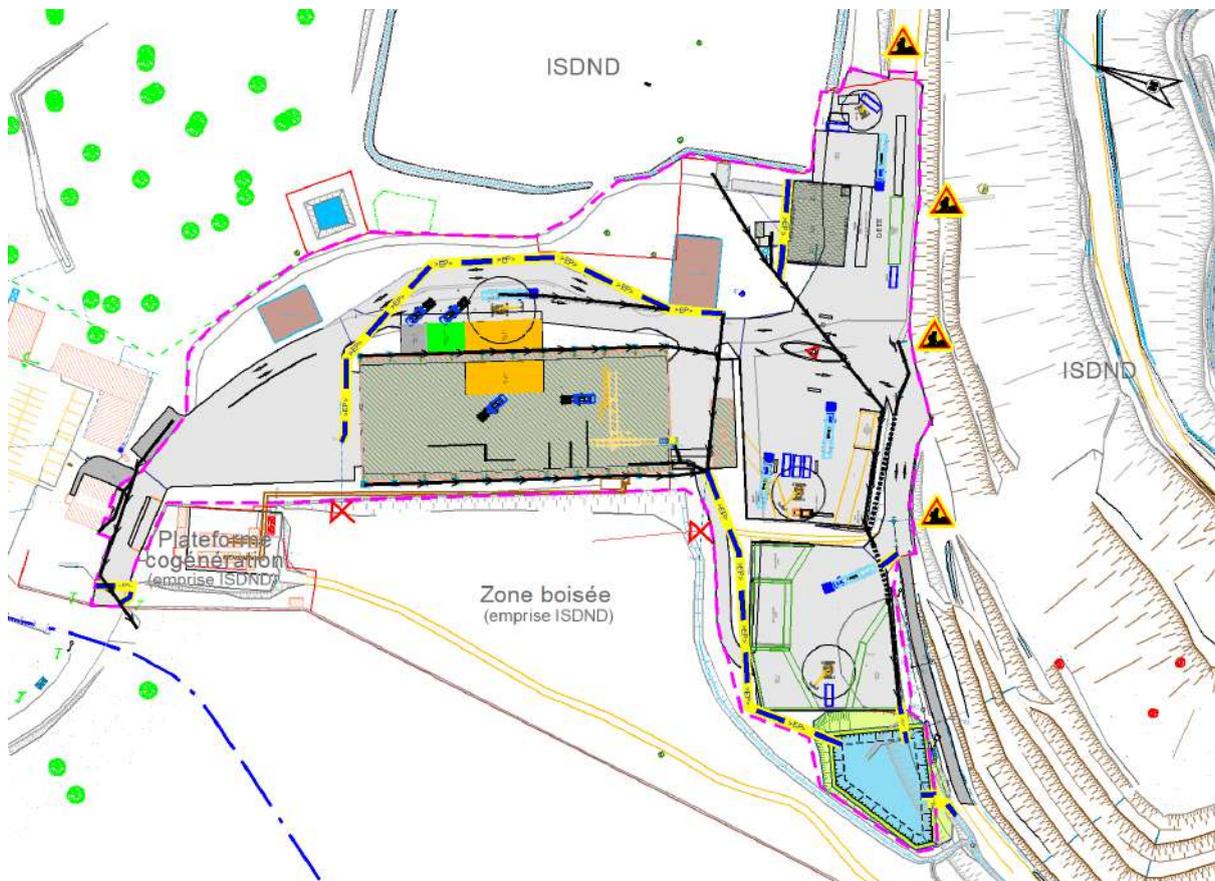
Plan de principe de gestion des EP (sans infiltration)
